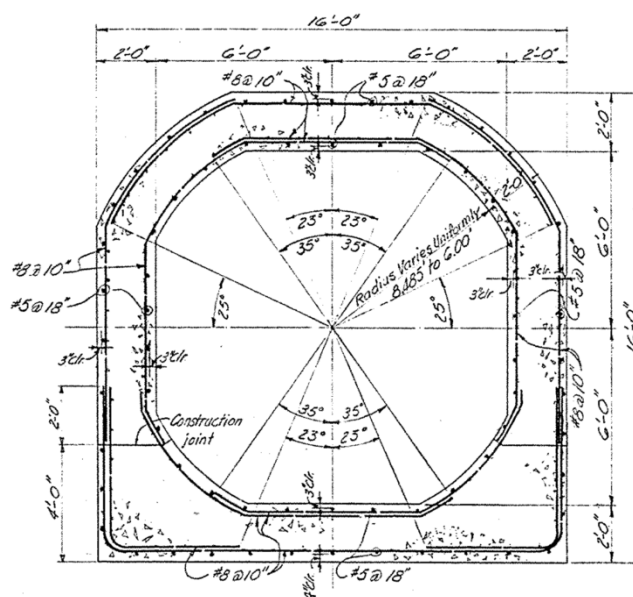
Sección transversal del conducto de toma horizontal de la presa
